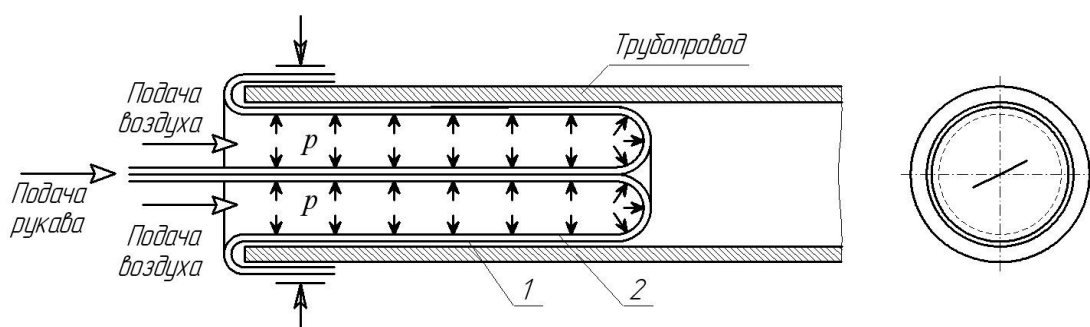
Рукавноторообразный привод: 1 – тканевая оболочка; 2 – плёночный рукав
